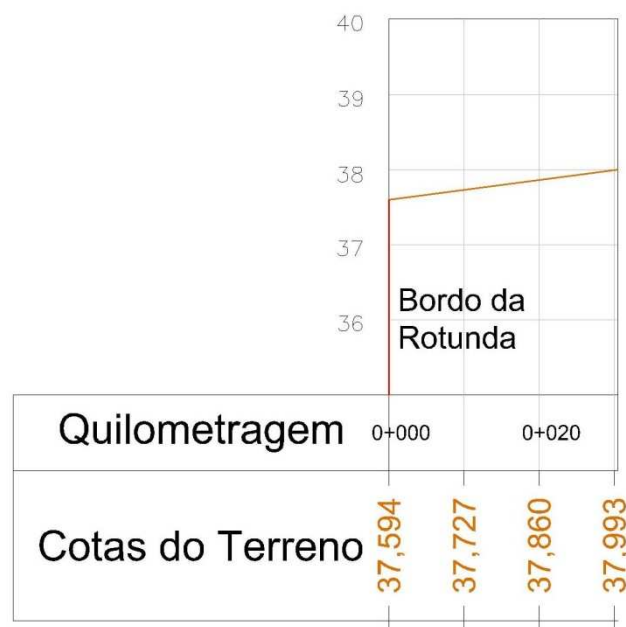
Perfil longitudinal do terreno pré existente do Ramo C.
